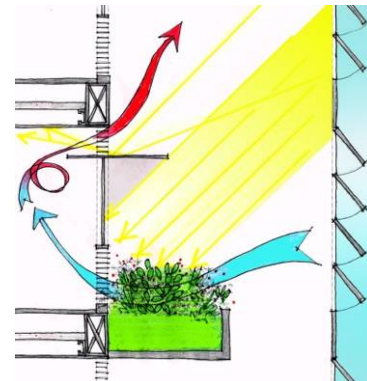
Esquema de ventilação e iluminação da fachada Sul:
